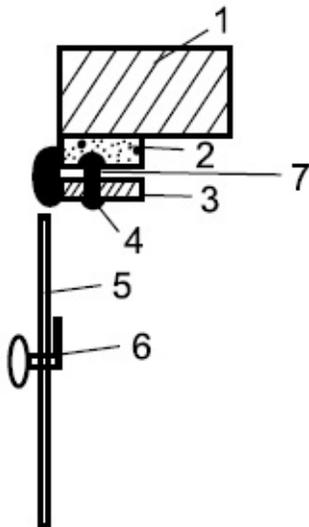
Установка печных приборов: 1 – кирпич; 2 – уплотнитель; 3 – рамка дверки; 4 – заклепка кляммера; 5 – дверка; 6 – ручка дверки; 7 – кляммер
